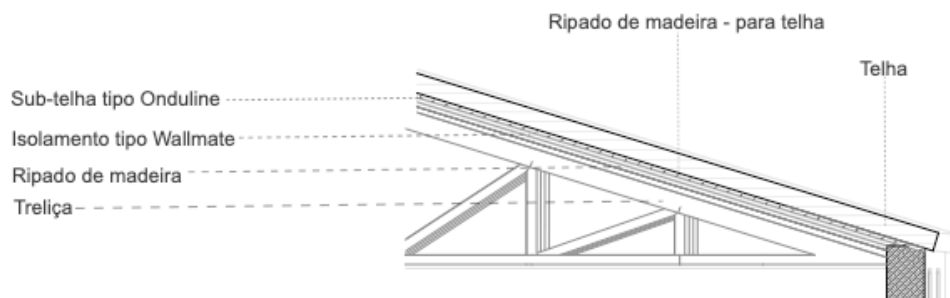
Pormenor construtivo Clube de Remo (fonte: autora)
